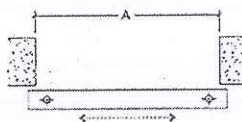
Detalle en planta de puerta industrial corredera apoyada
